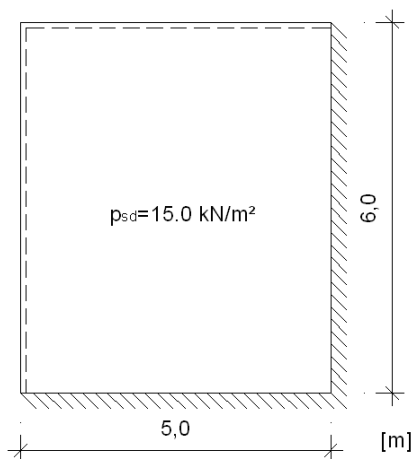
Laje encastrada em 2 bordos e simplesmente apoiada nos outros 2 bordos
